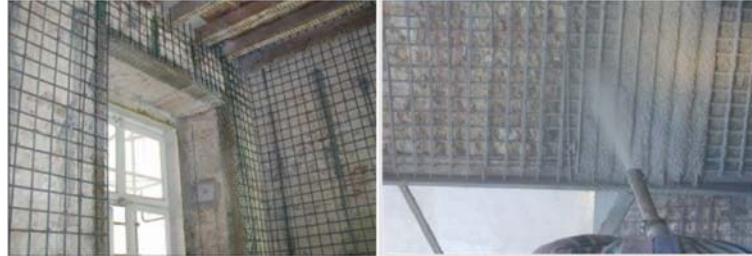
Refuerzo recrecido con hormigón proyectado [6]
